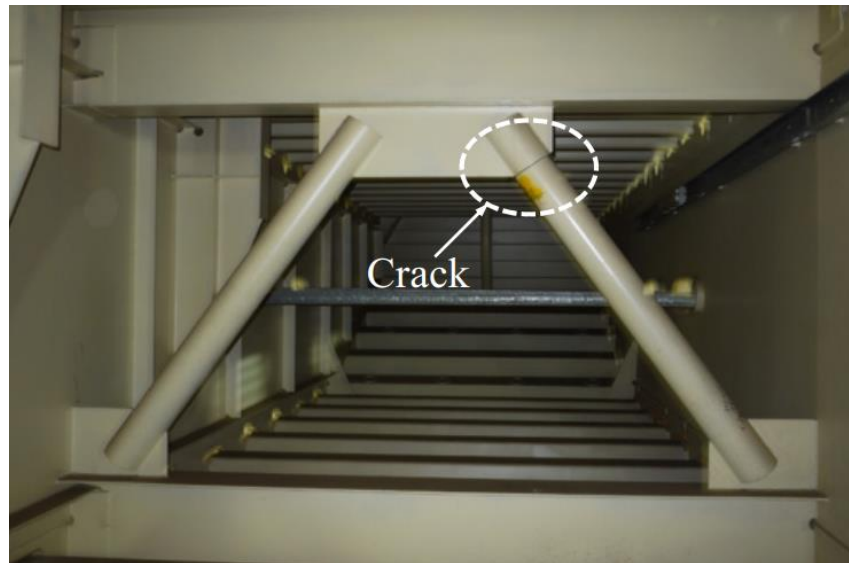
Grietas observadas en el campo en los diafragmas longitudinales de las vigas cajón: grieta a través de toda la sección (SNYB).
